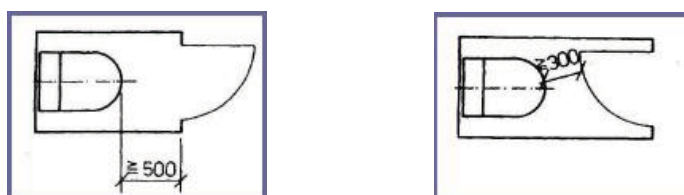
Půdorysné rozměry záchodových kabin [16]
